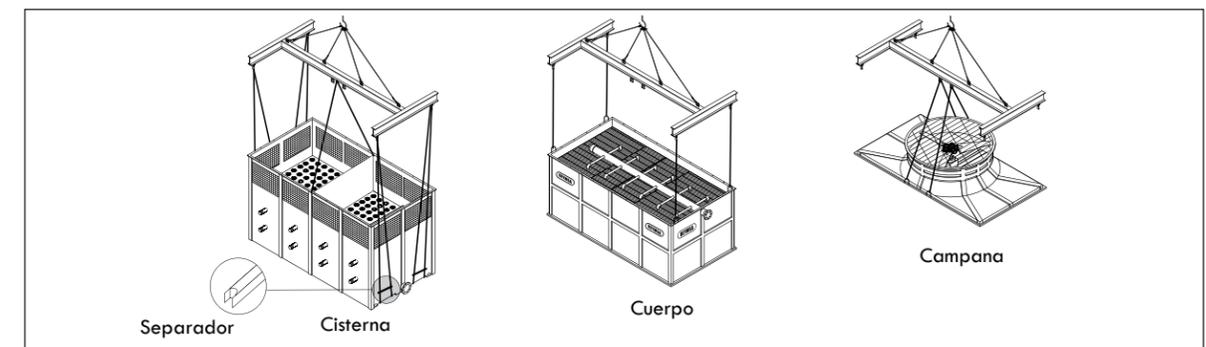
Levantamiento con grúa de una torre modelo HFC-F
